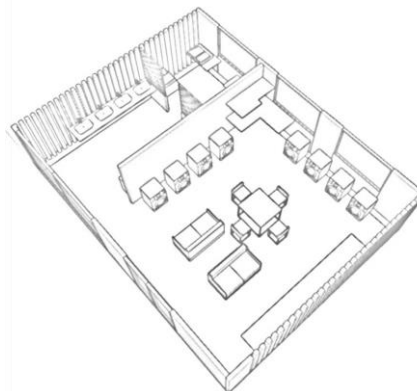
Lavandería, espacio colectivo.* Fuente: Elaboración propia
